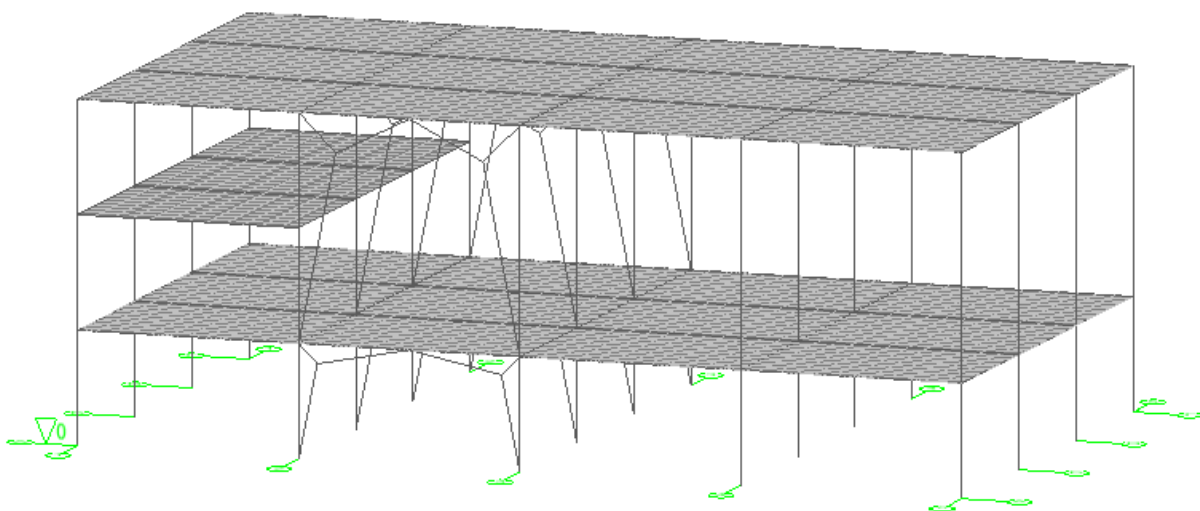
Расчетная схема с плитами перекрытия
